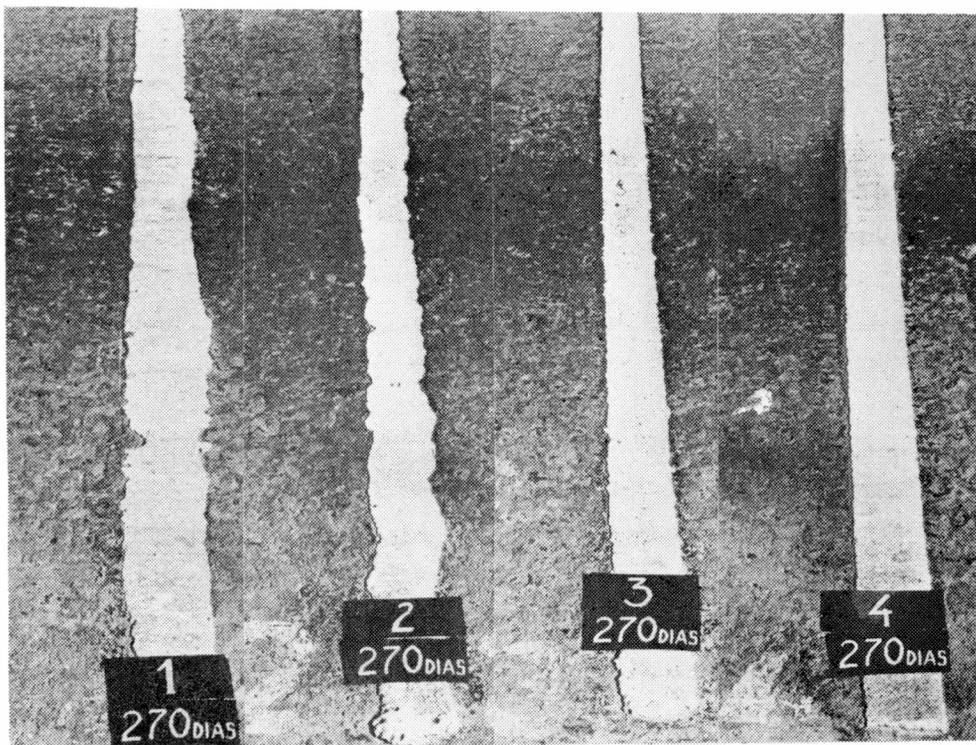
Termoplásticos aplicados sobre pavimento de hormigón luego de 270 días de ensayo en servicio
